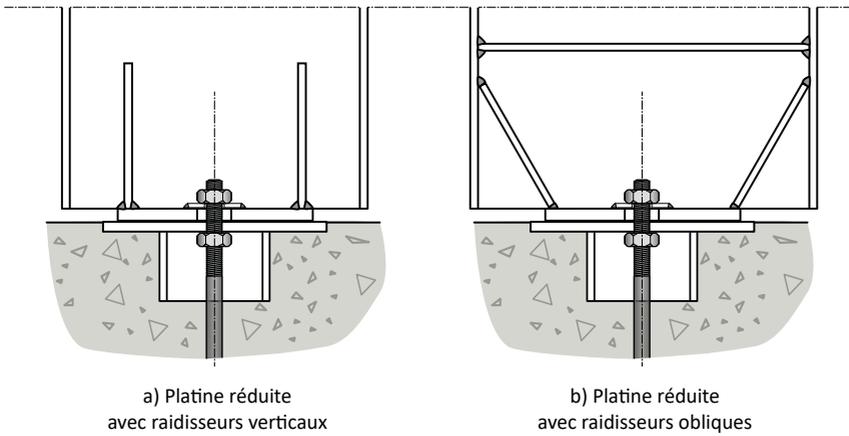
Pieds de poteaux articulés avec platine réduite centrée
